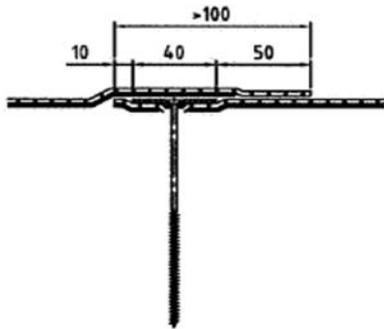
Joint longitudinal en cas de système fixé mécaniquement
